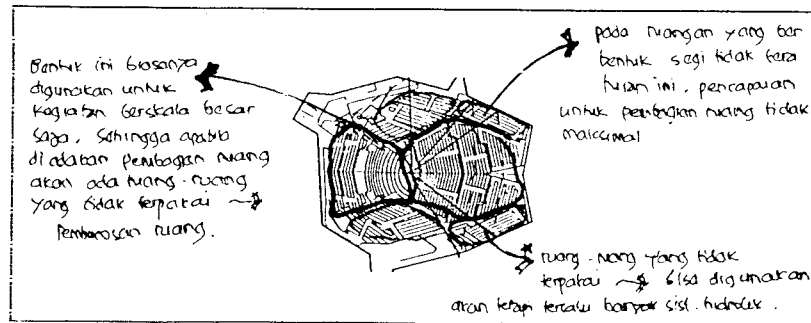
Analisa fleksibilitas (pembagian ruang) bentuk ruang kipas (fan shape).
